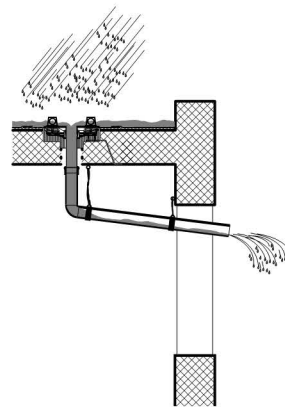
Provisorische Baustellenentwässerung mit dem Pluvia Grundelement
